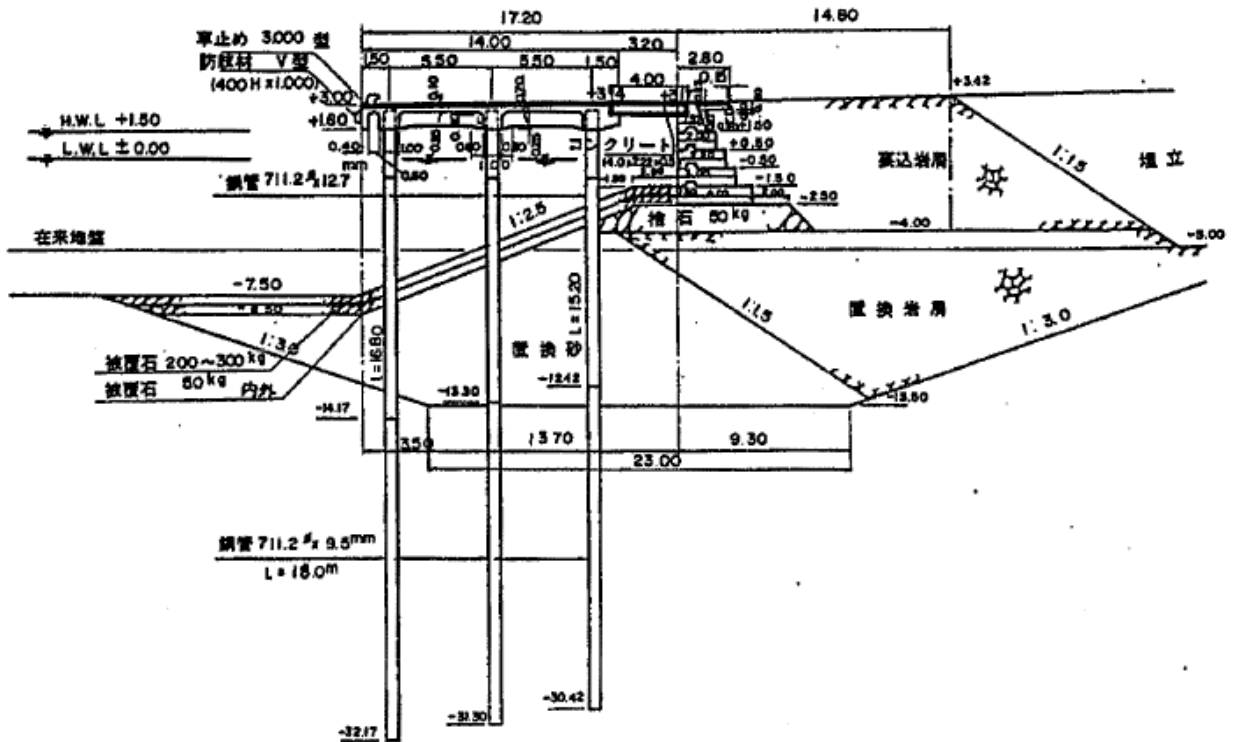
須賀地区栈橋 (-7.5m) の標準断面図
